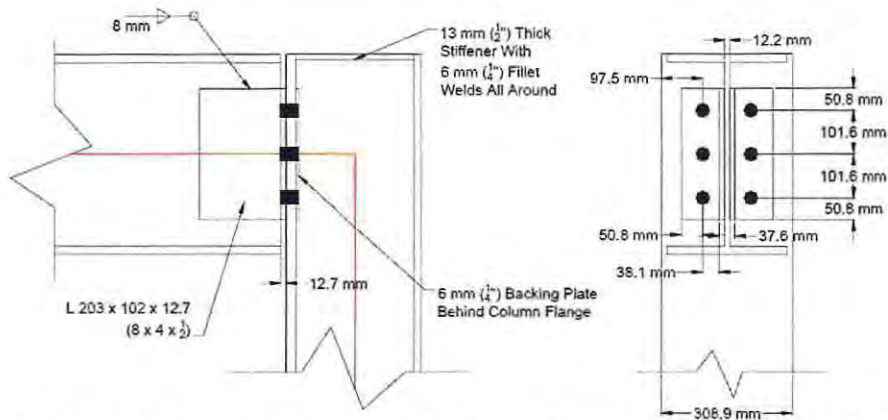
Detalle de conexión simple viga-columna de una muestra de SPSW. Fuente: [2].
